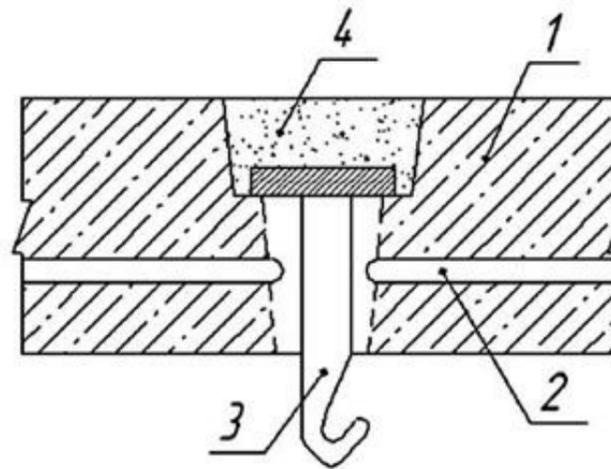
Схема конструктивного решения выпуска провода из перекрытия к поточному светильнику (перекрытие со сквозным отверстием):
